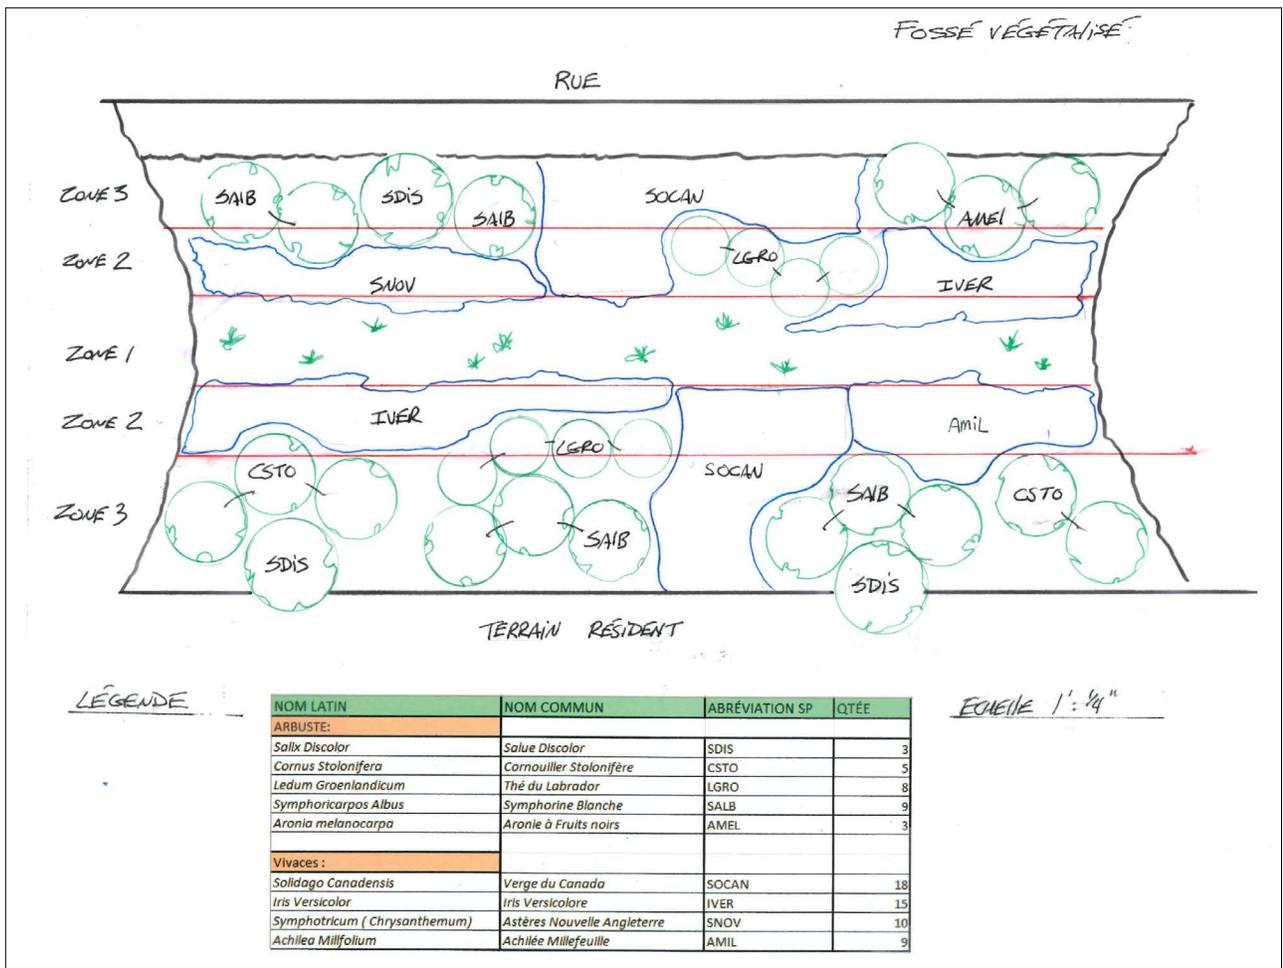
Exemple d'un plan d'aménagement de fossés
